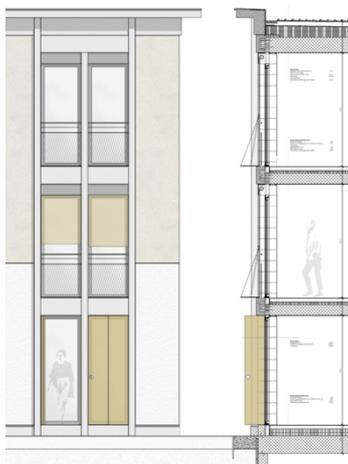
Materialisierung und Konstruktion (original 1:20)
